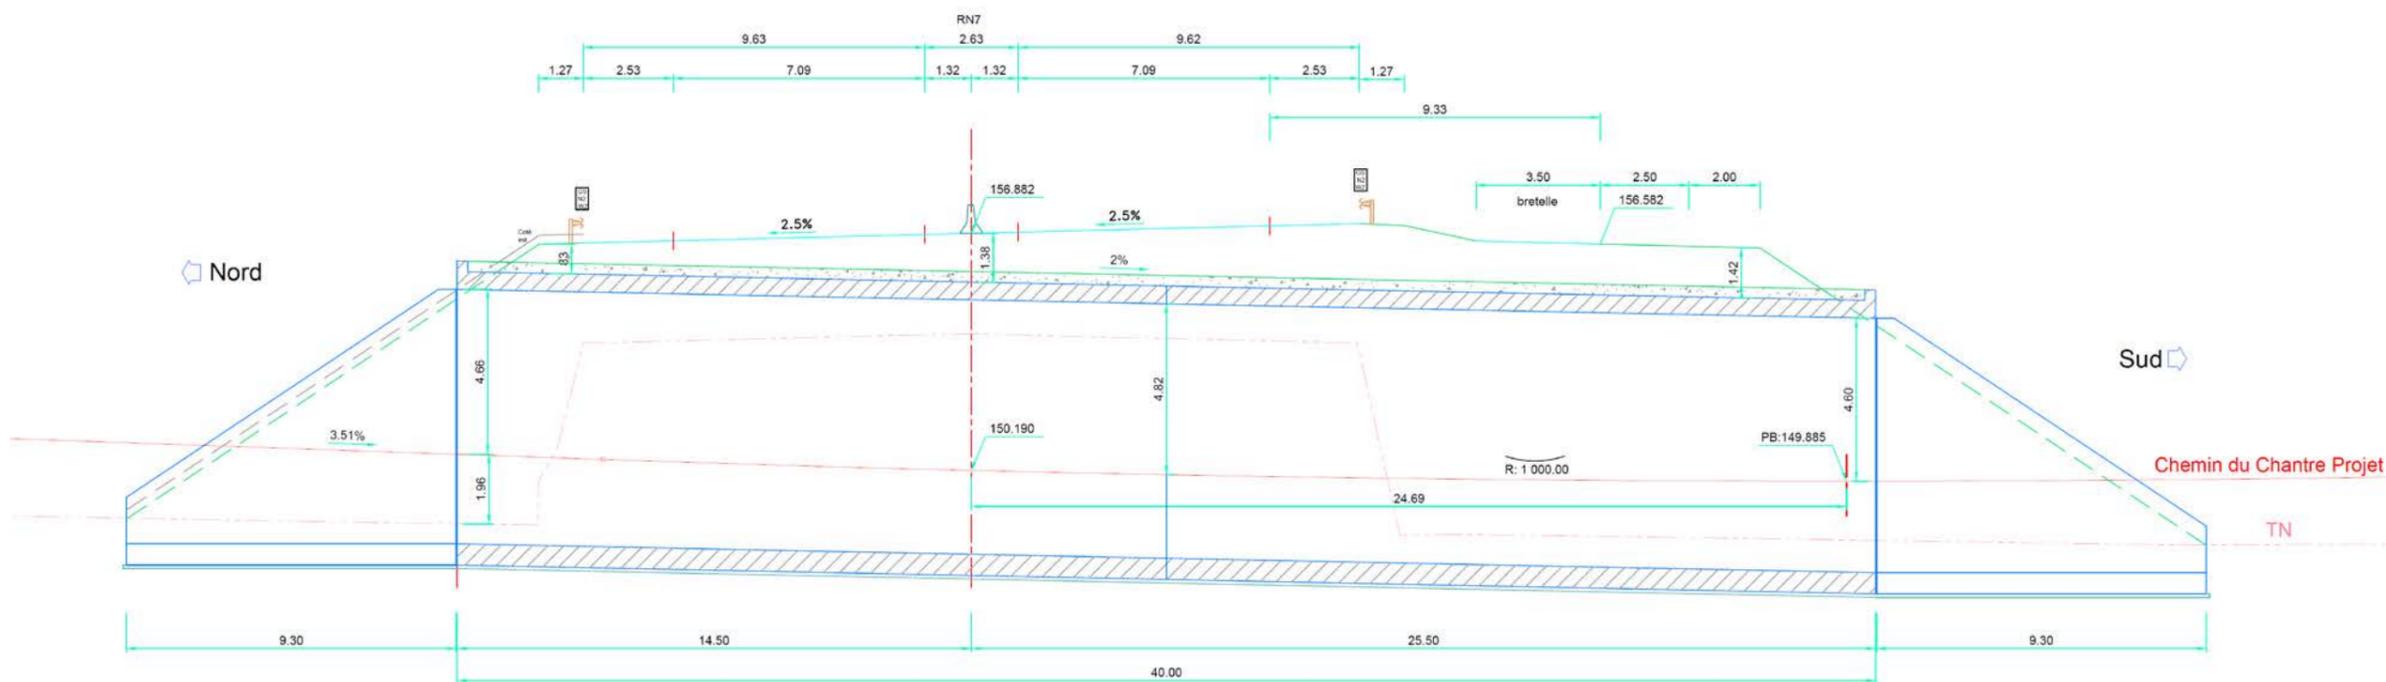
Coupe longitudinale de l'ouvrage d'art OA1
